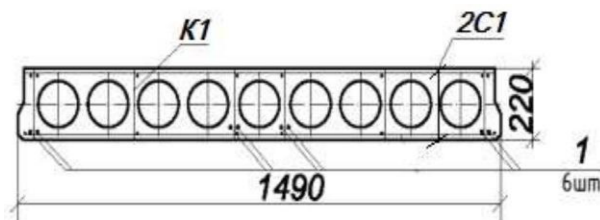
Схема армування плити з поздовжньою робочою арматурою
